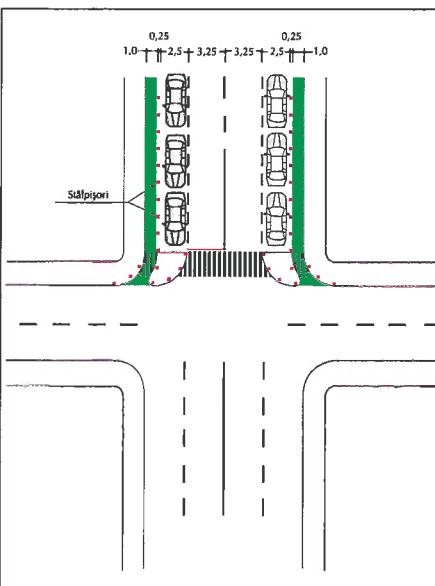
Soluție de amenajare a străzilor (vedere în plan)
